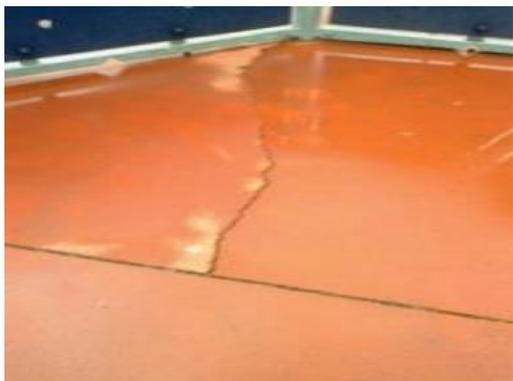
Fissuras aleatórias por falta de estudo geológico/geotécnico - loures
